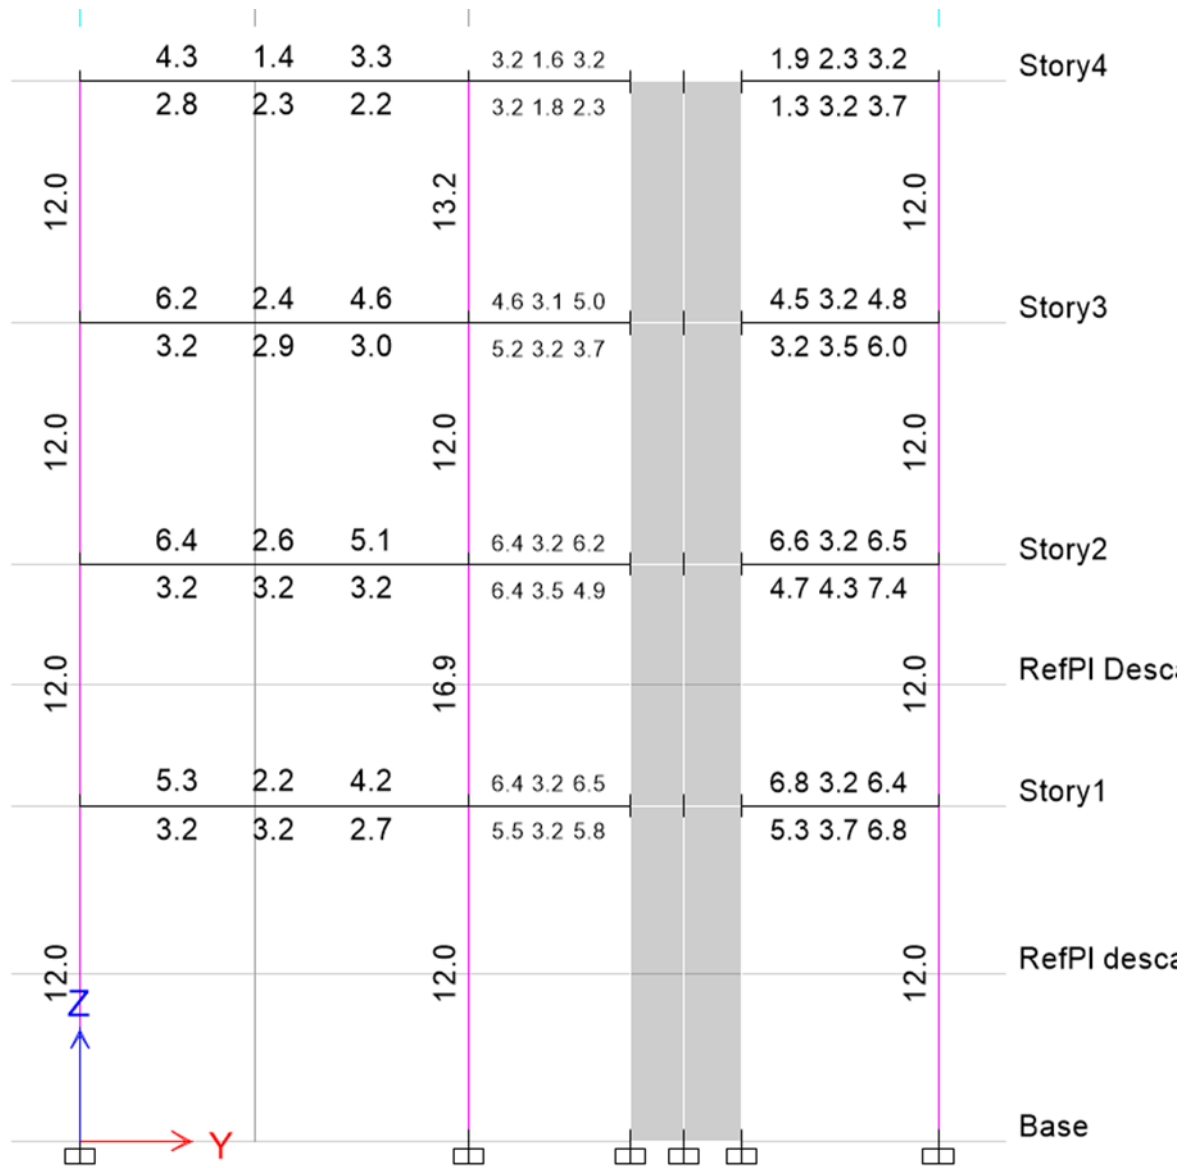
Acero de refuerzo para las vigas del eje A.
